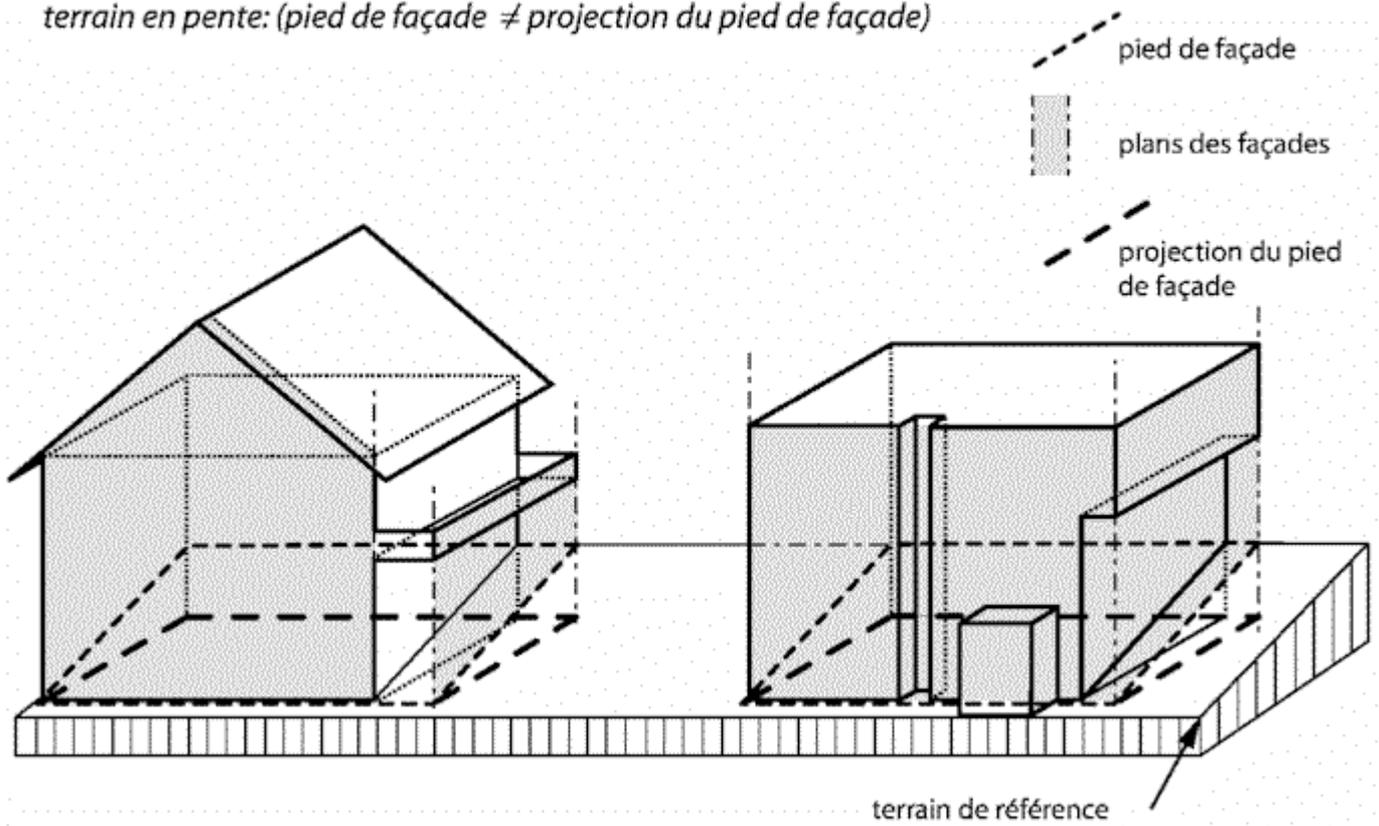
b Plans de façades et projection du pied de façade (sur terrain en pente)
